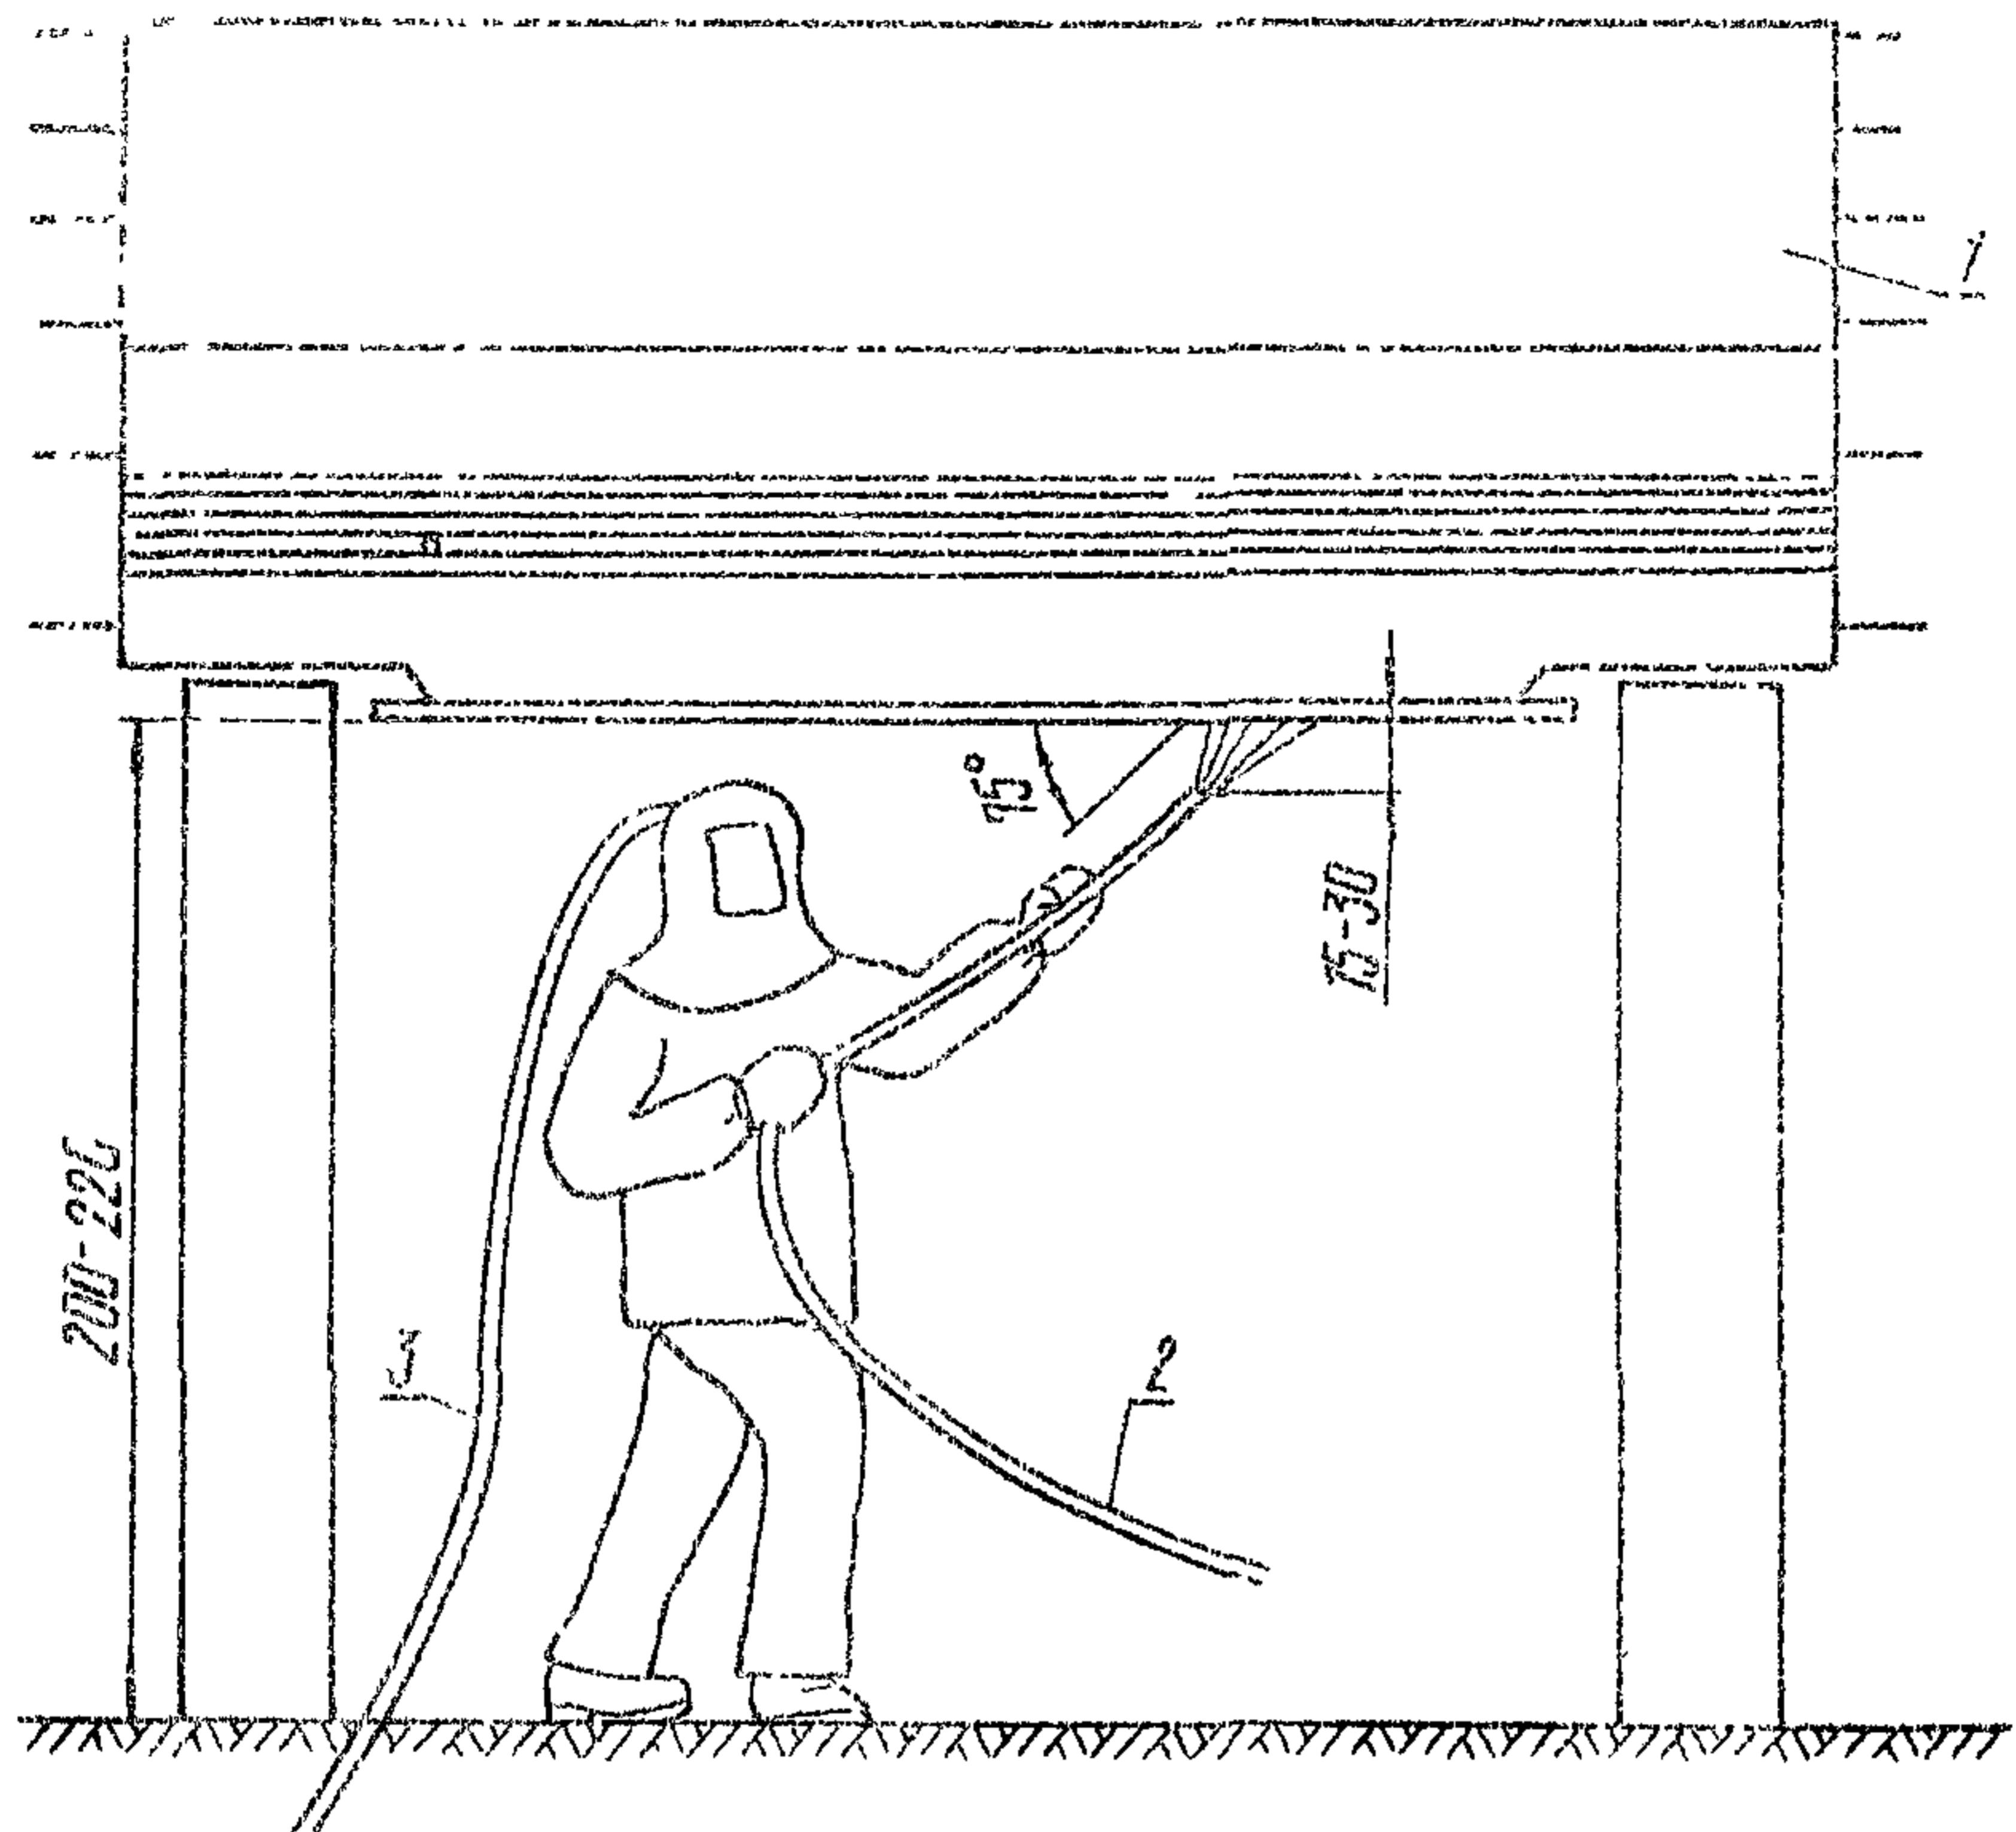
Эстакада для пескоструйной обработки поверхности закладных деталей соединения плит проезжей части с балками:
